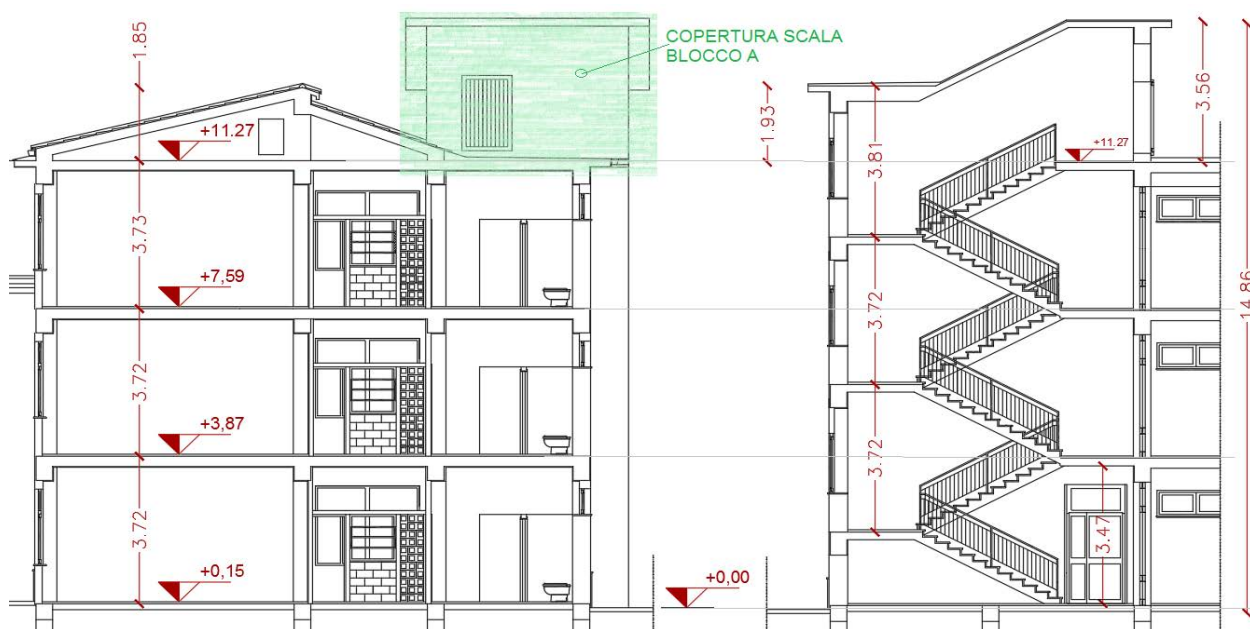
STRALCIO SEZIONE TRASVERSALE TIPO E SEZIONE LONGITUDINALE IN CORRISPONDENZA DEL VANO SCALA BLOCCO A
